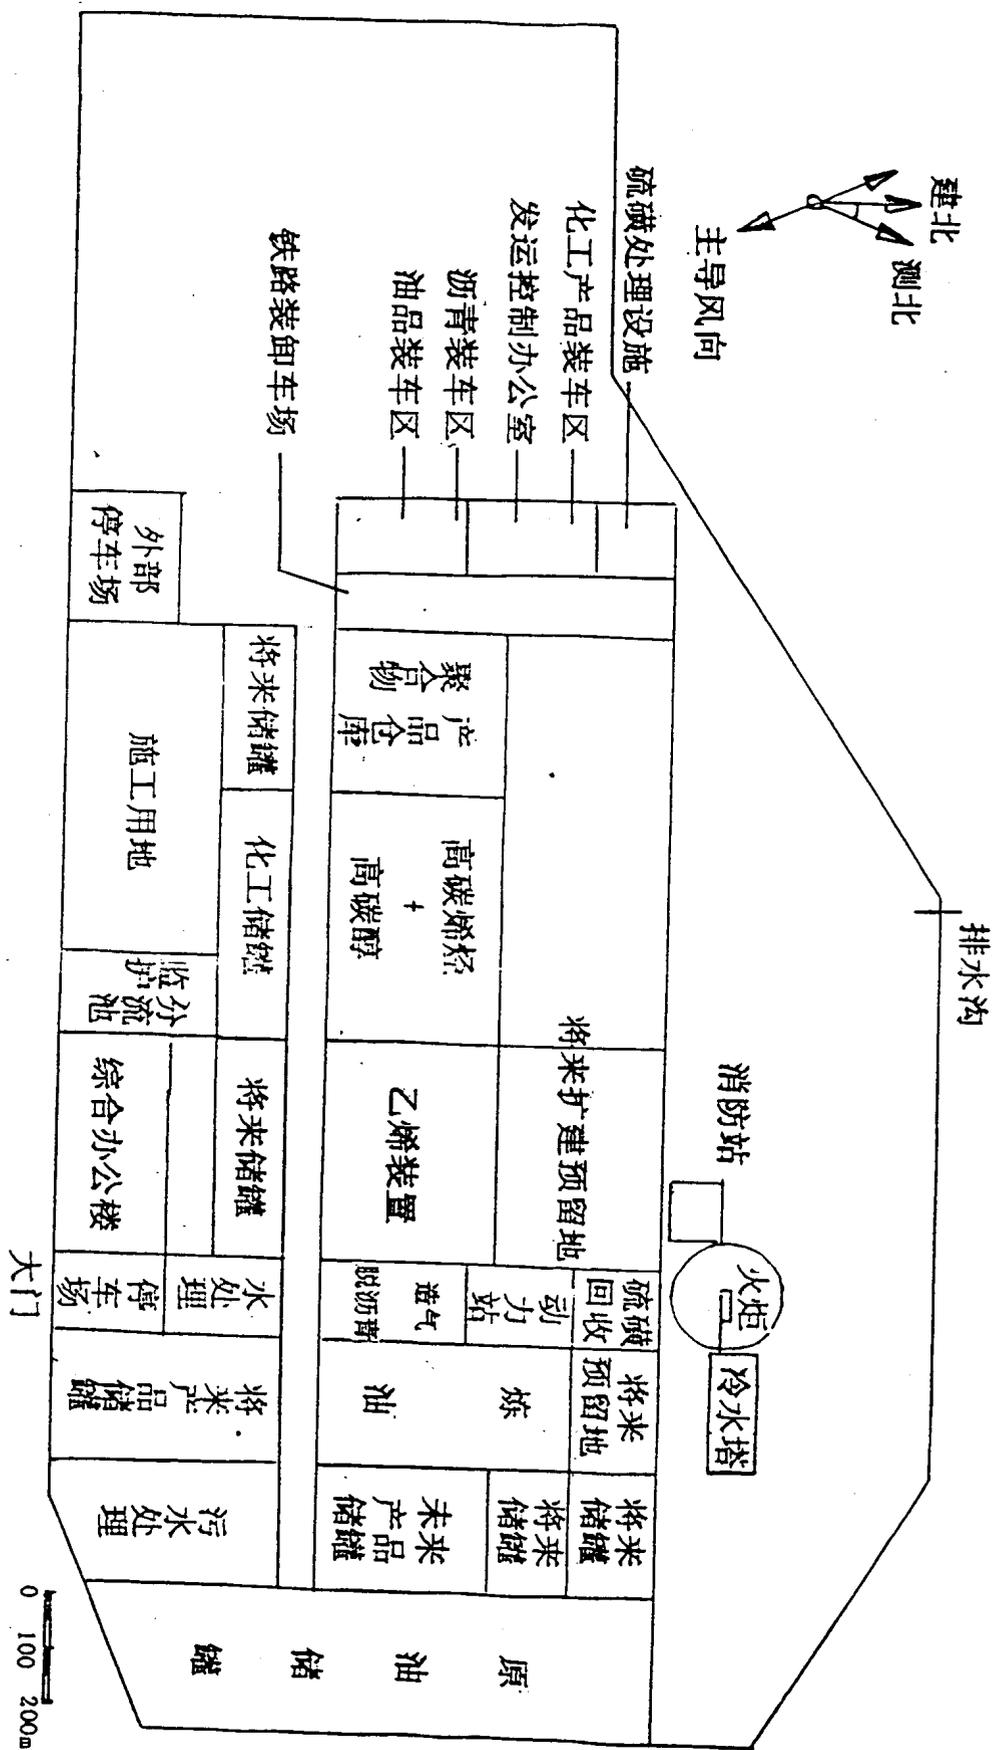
炼油和乙烯联合装置全厂总平面布置示意图
